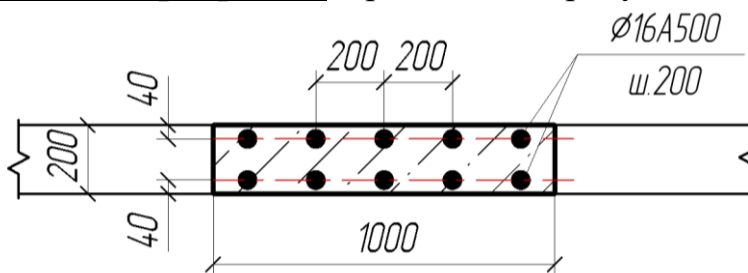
Расчетная схема ж.б. плиты перекрытия. За расчетное сечение принимается полоса шириной 1 м
